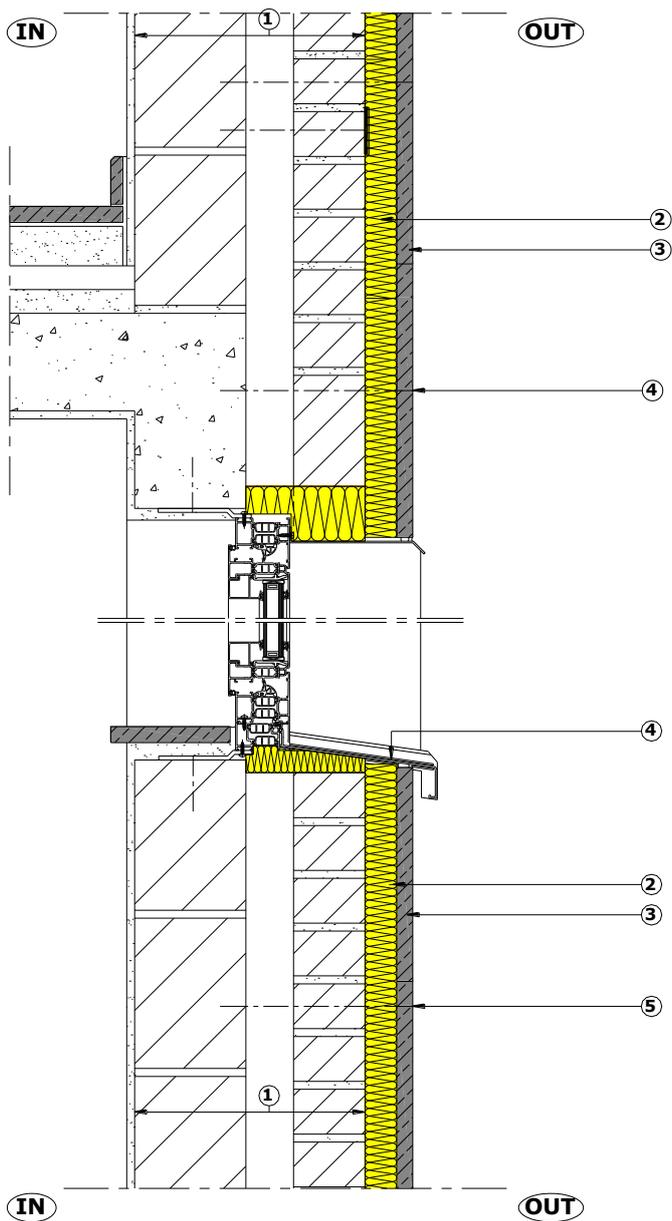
DETAILS FINITION DES POURTOURS DE BAIE AVEC PROFILS ALUMINIUM
